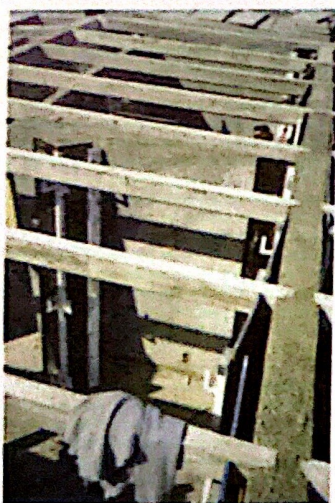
Cubierta de componentes premoldeados livianos de microhormigón. Sistema Consur 1.
